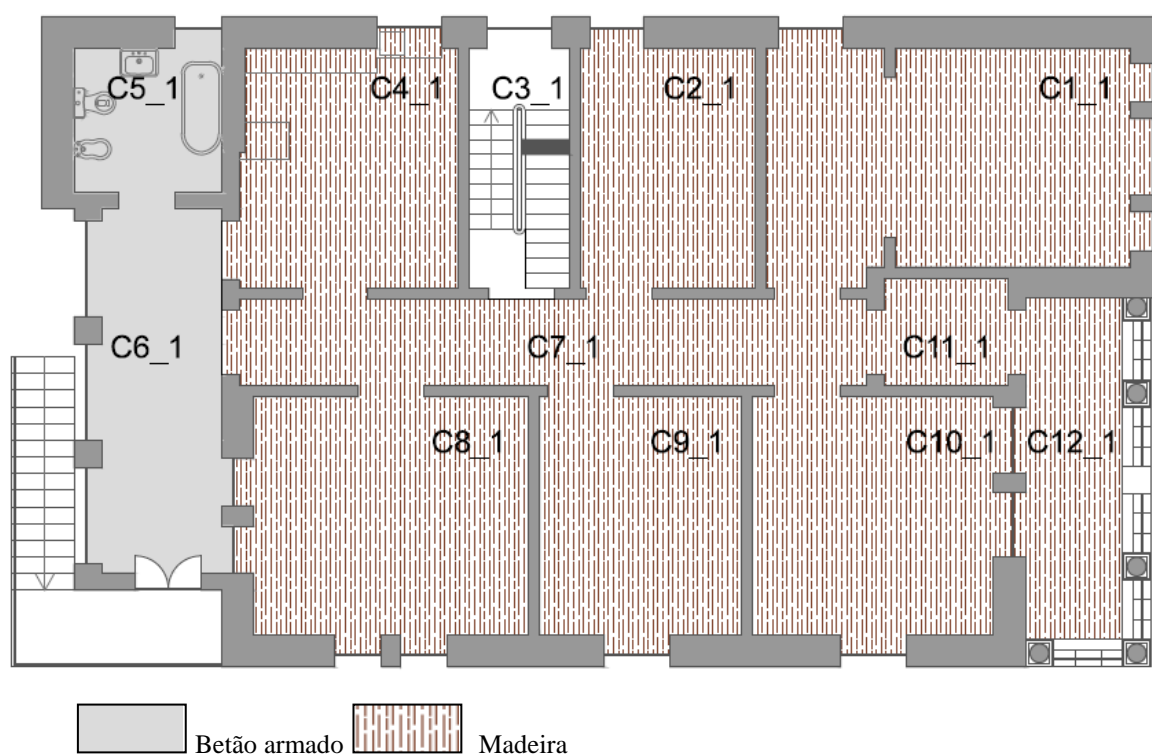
Representação da estrutura do pavimento. Piso 1
